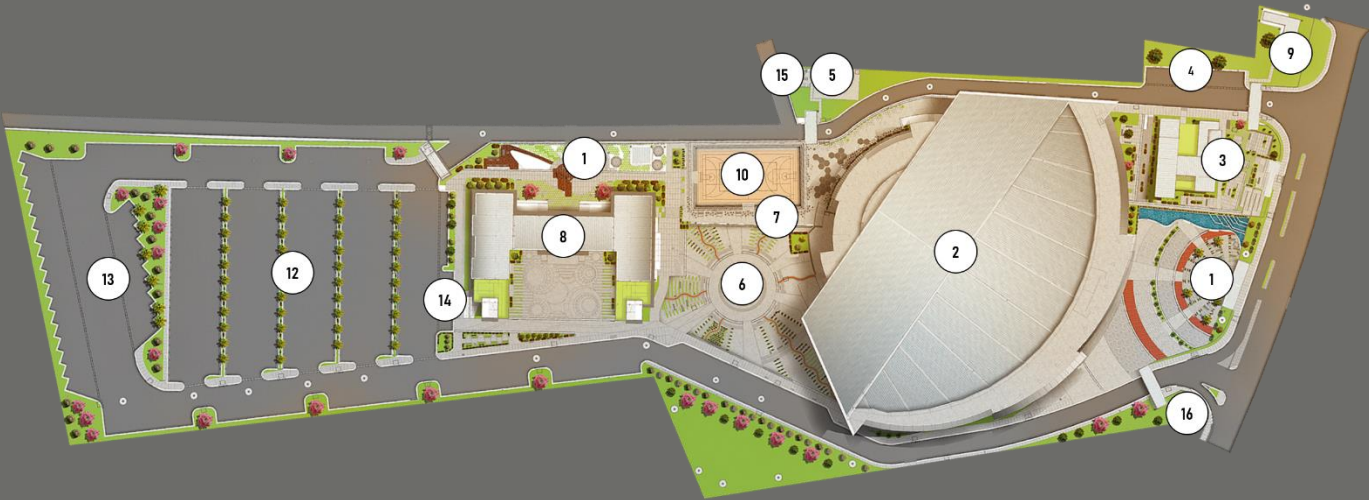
Planta de conjunto del proyecto Ríos de Agua Viva
